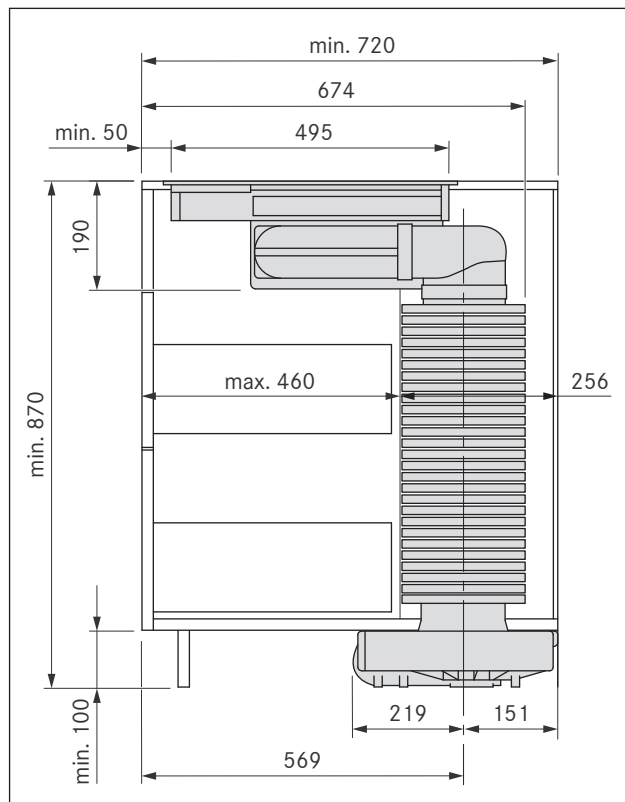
Dimensões de montagem do aparelho com silenciador redondo USDR50
